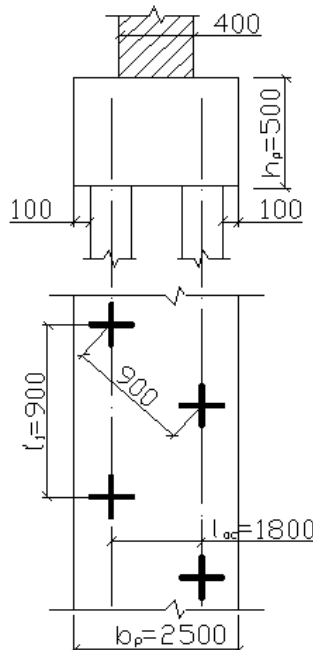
До розрахунку буронабивного фундаменту в 2 – му перерізі
